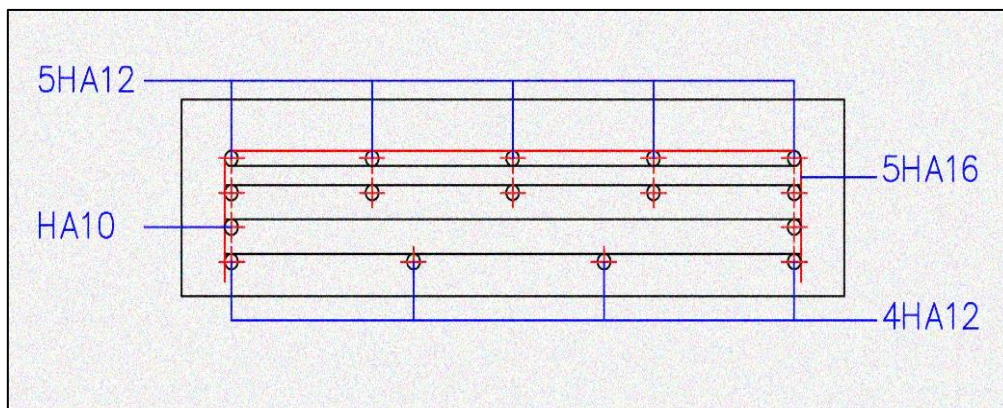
La coupe longitudinale de ferrailage du dé d'appui.
